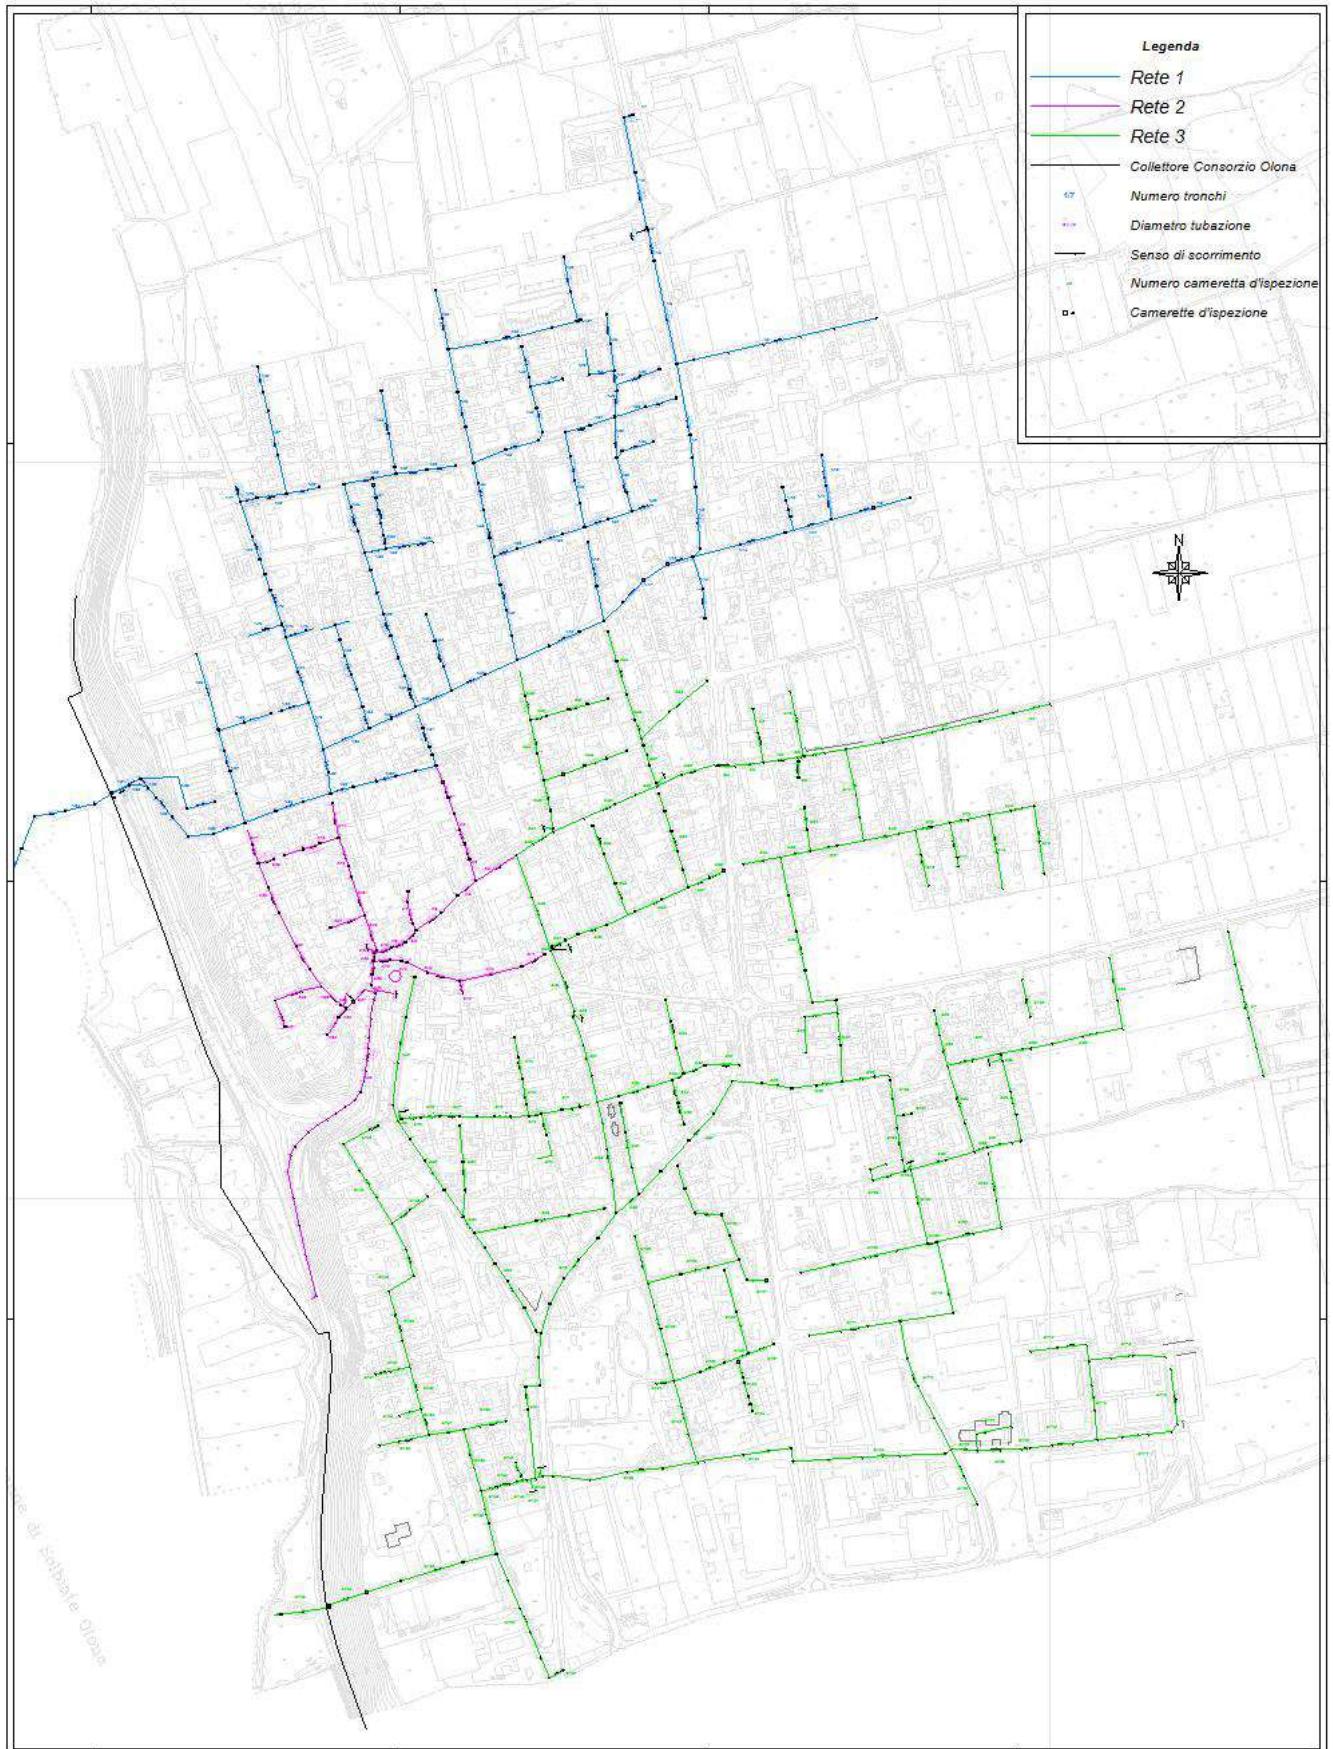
planimetria Rete fognaria comunale secondo la suddivisione in settori funzionali – fonte UTC
